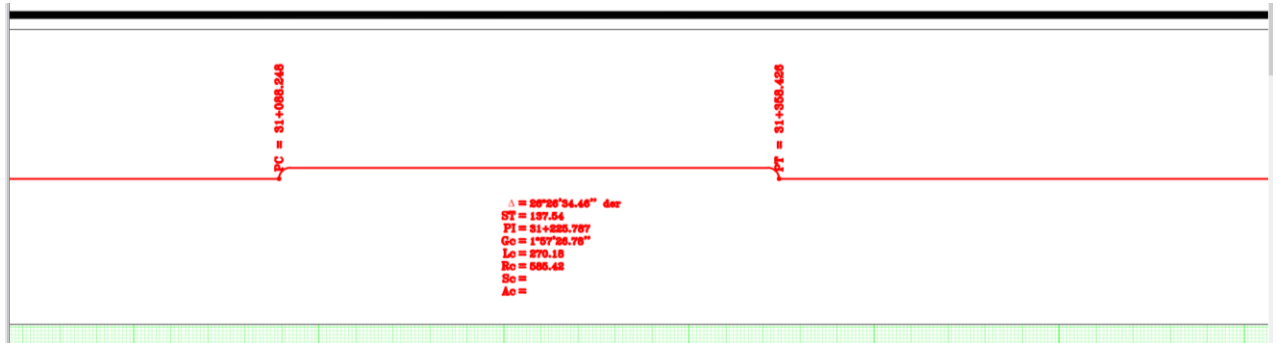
Planta Esquemática en el Perfil de Trabajo
